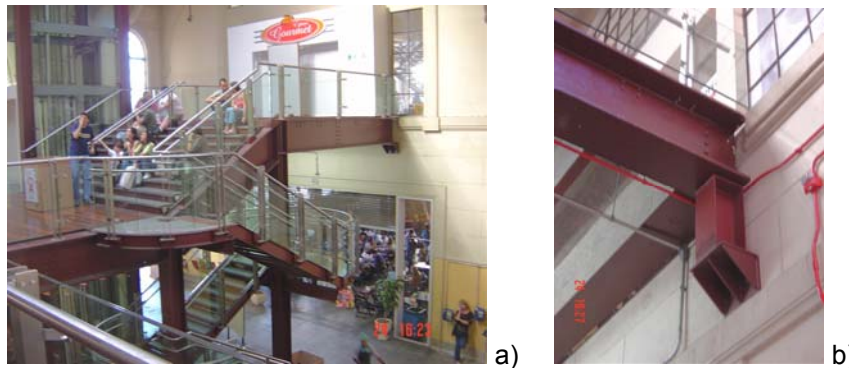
Ligação da estrutura metálica e da edificação já existente.
